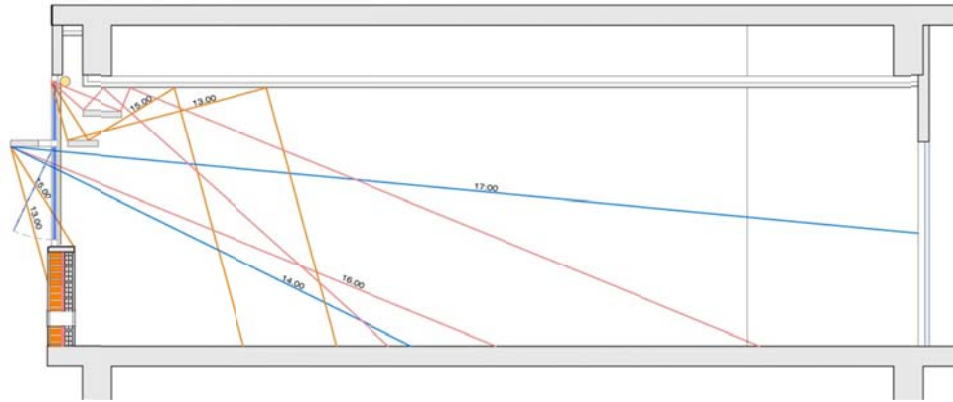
Propuesta de carpintería, parasoles horizontales y estantes de luz, fachada norte
